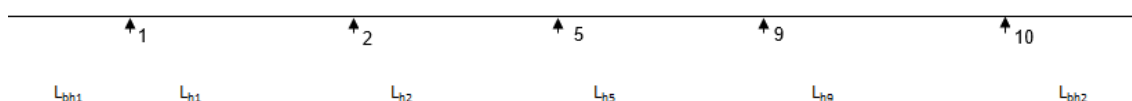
Esquema estrutural para a direção horizontal – painéis 1.
